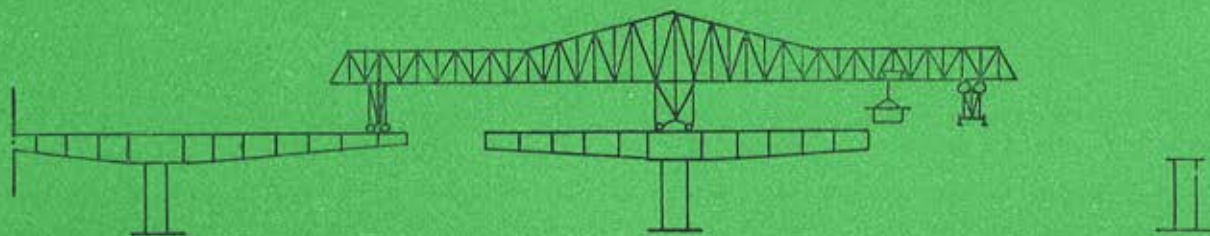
Detalle del dispositivo utilizado para la colocación de las dovelas prefabricadas en el puente de l'Île-d'Oleron (Francia).
